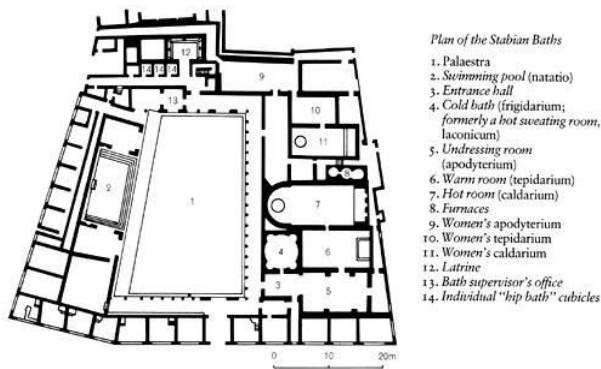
PLANTA DOS BANHOS DE STABIANO, POMPEIA
